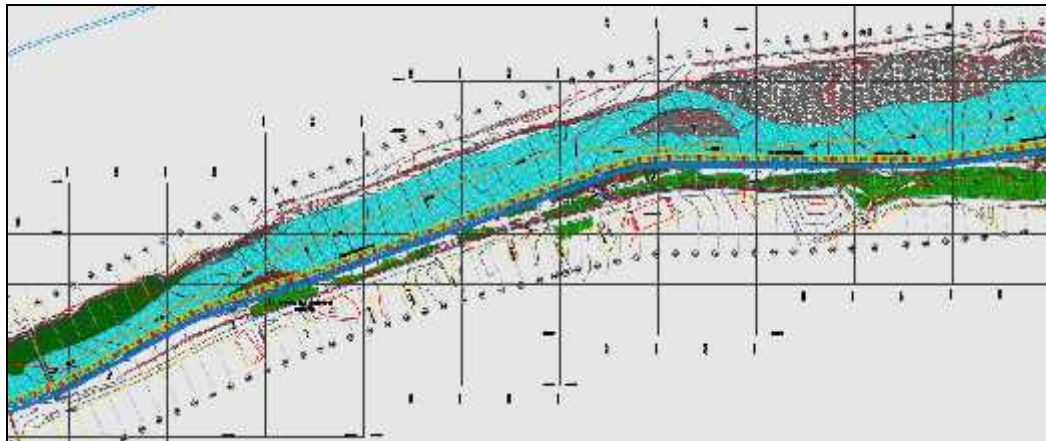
Vista en planta de la línea del thalweg - 2+940 @ 4+160.
